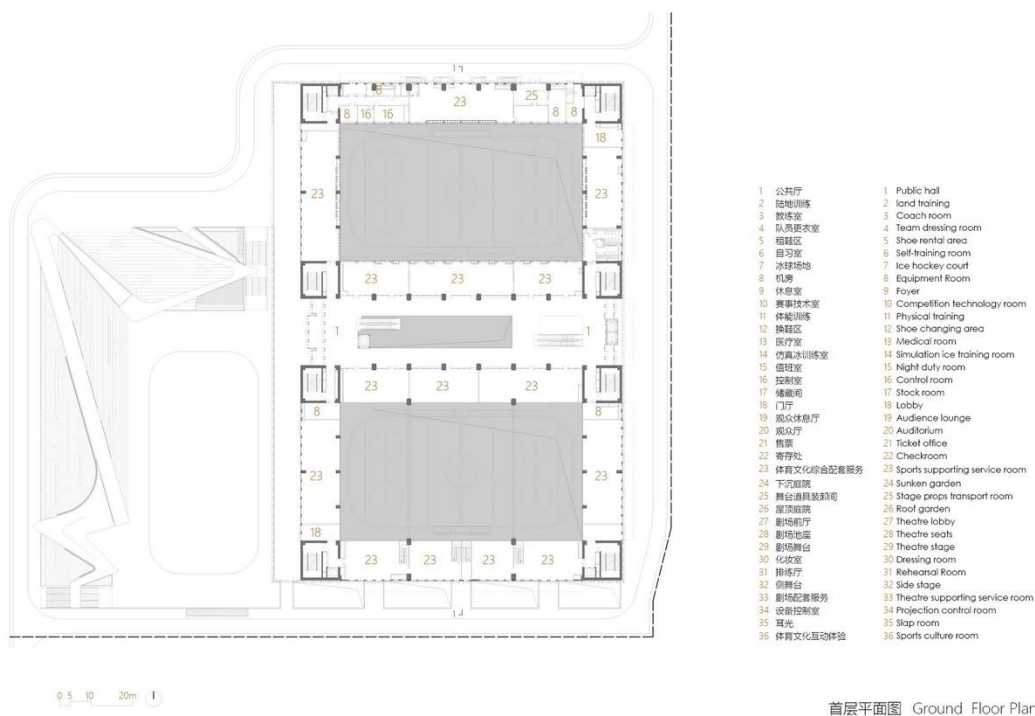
План первого поверху, арх. VIAD-ZXD ARCHITECTS [1]
